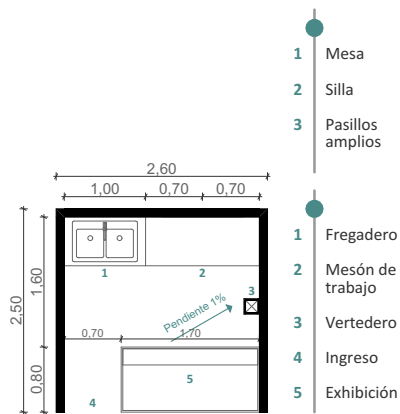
Planta de jugos y batidos. Fuente: Autores.
